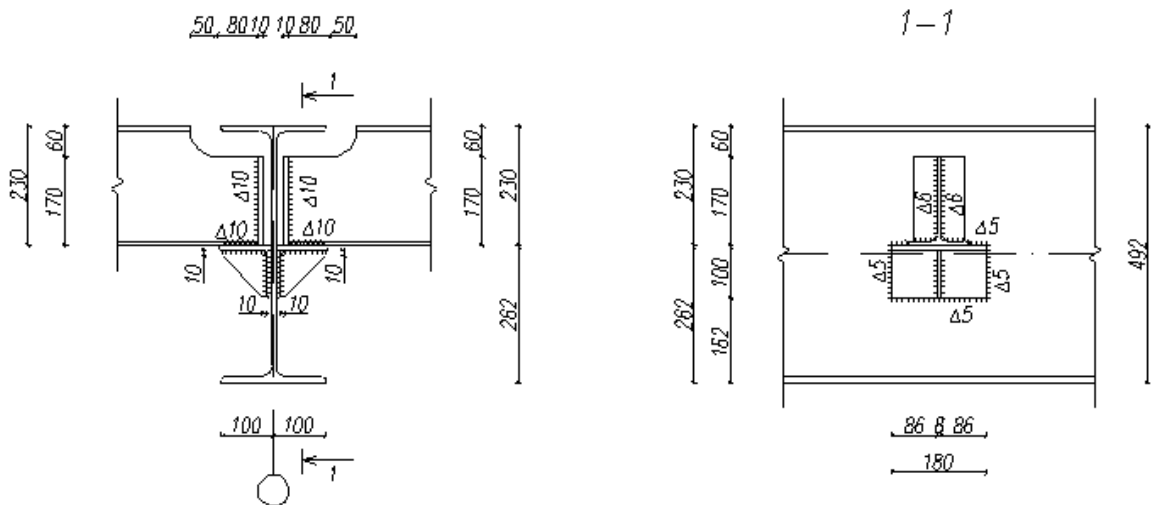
Схема кріплення прогонів 30Б1 до ригелів.
